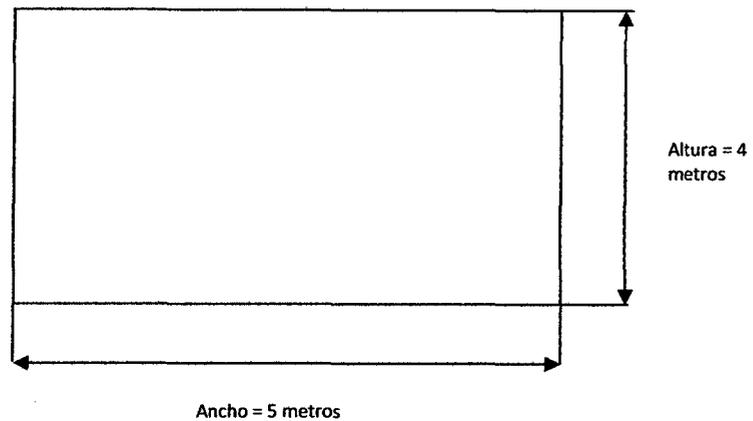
Sección recta promedio galerías mina Limpe Centro
